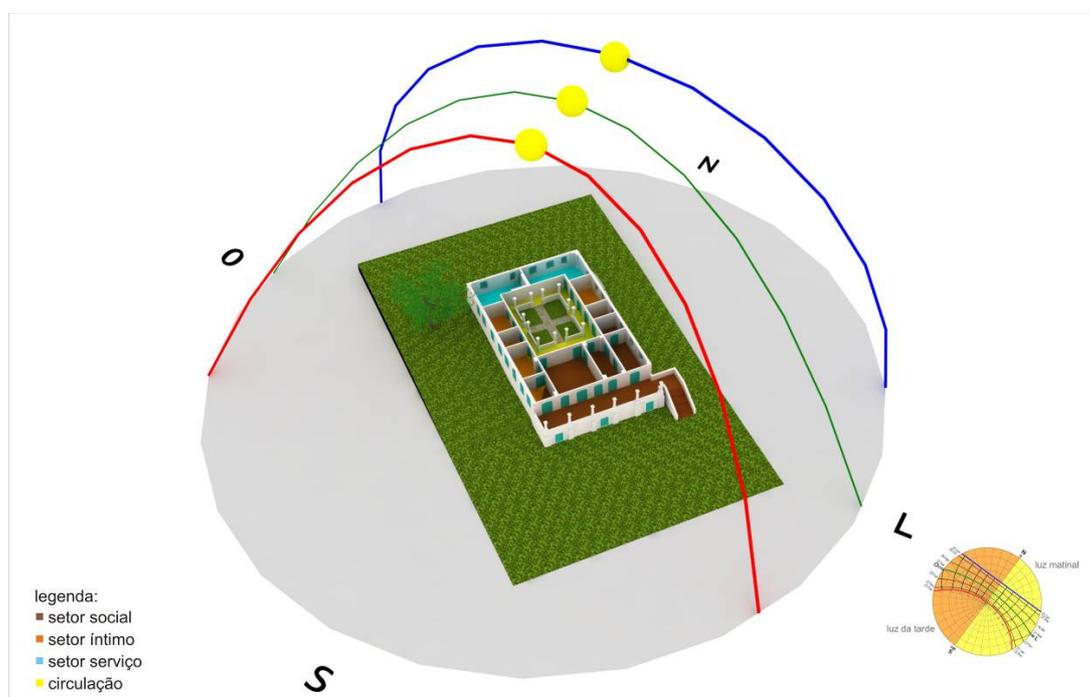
Planta setorizada da edificação destacando a trajetória solar.
